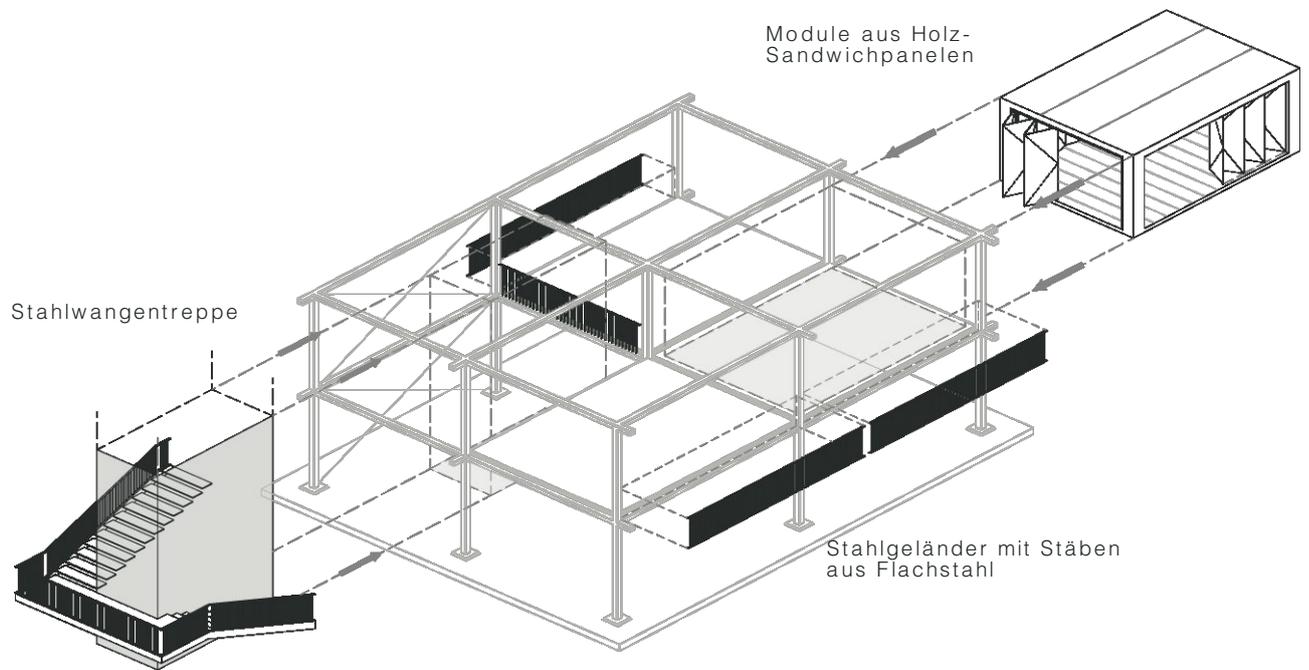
Erweiterung der Konstruktion durch Module, Treppen und Geländer
